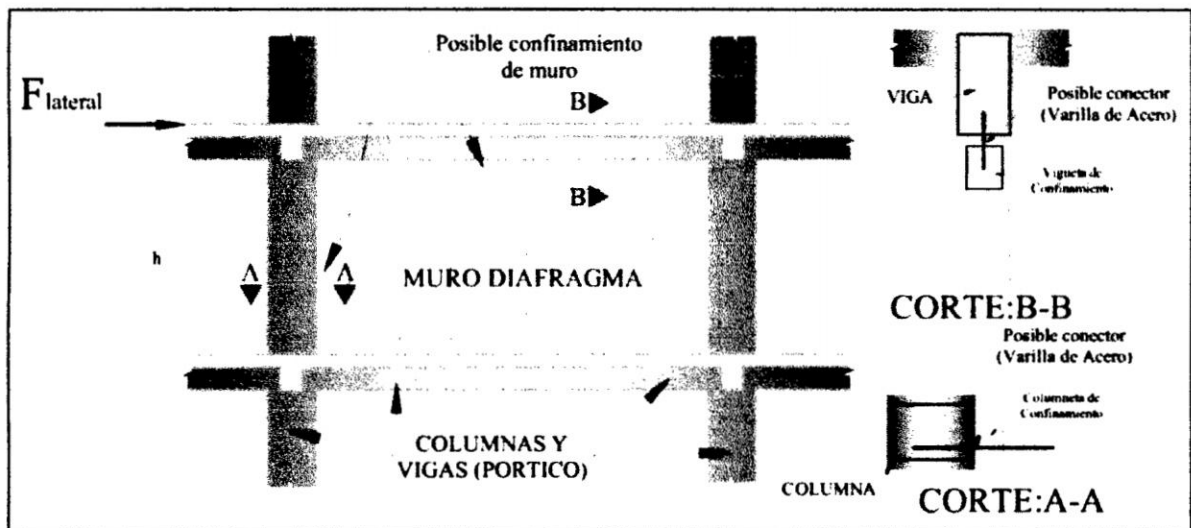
Detalle en planta y elevación de Muro relleno (Diafragma)
